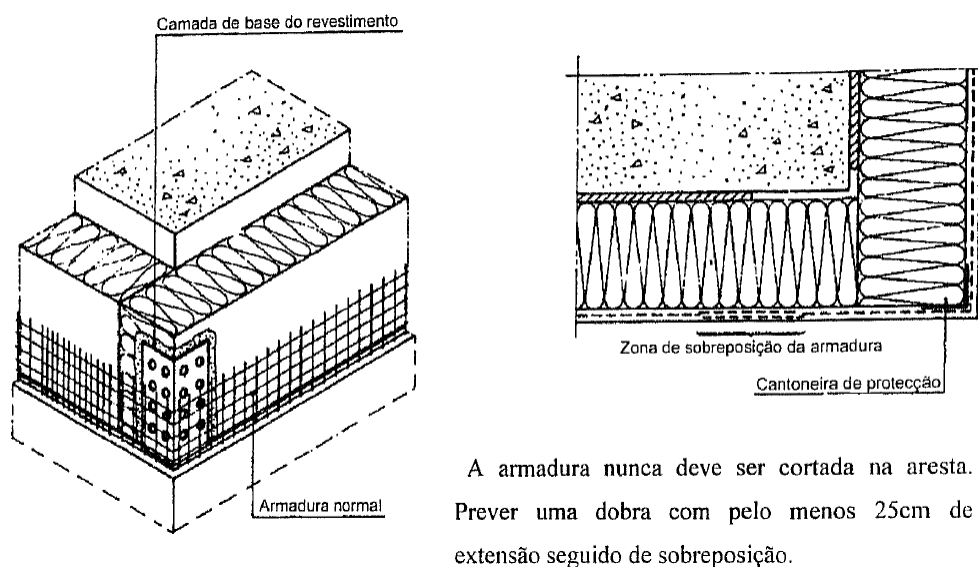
Cantoneiras de proteção das arestas verticais do sistema [19]
